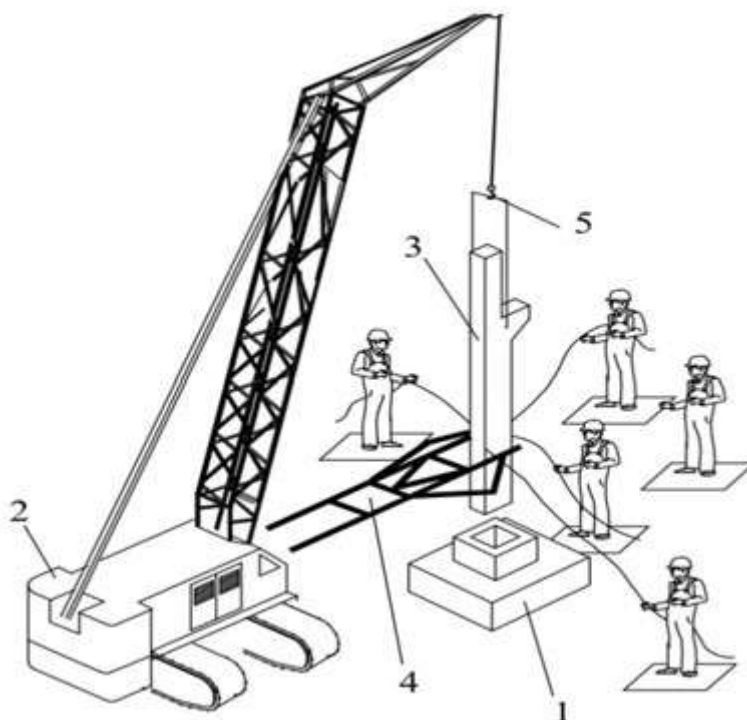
Органзація робоого місця монтажників при встановленні коони: 1– фундамент стального типу; 2 – монтажний кан; 3 – залізобетонна колона; 4 – жорсткий мотор; 5 – захоплюючий пристрій
